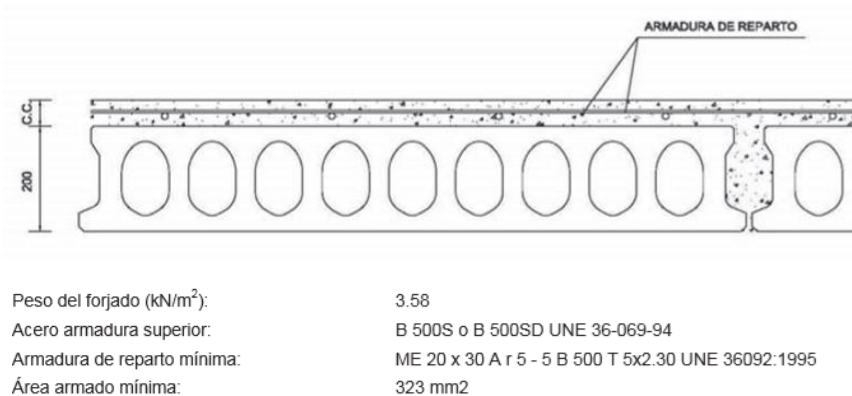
Forjado de cubierta. [Fuente: Aljema Prefabricados](#)
